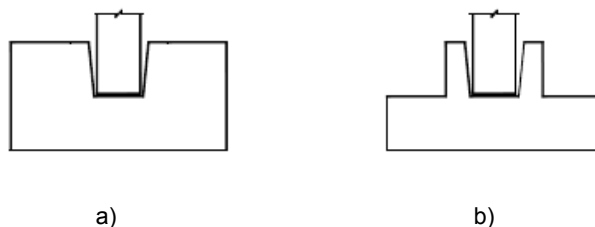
Ligações pilar - fundação mais correntes (extraída de [3])
